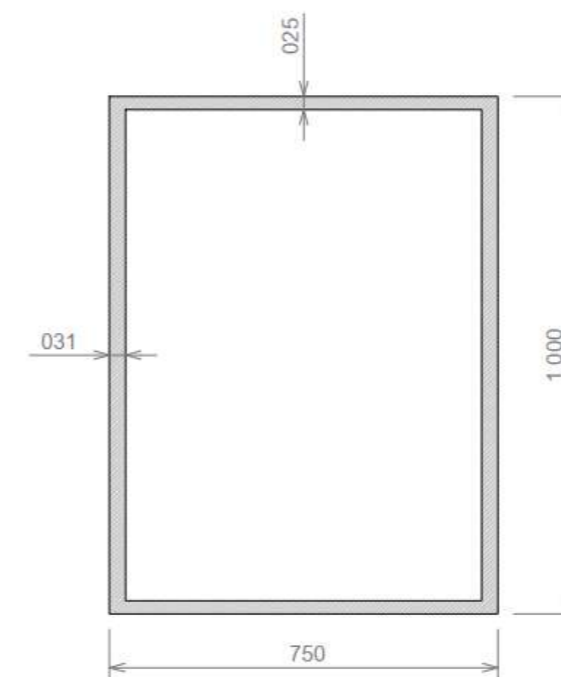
Sección transversal de las riostras (fuente: elaboración propia)
